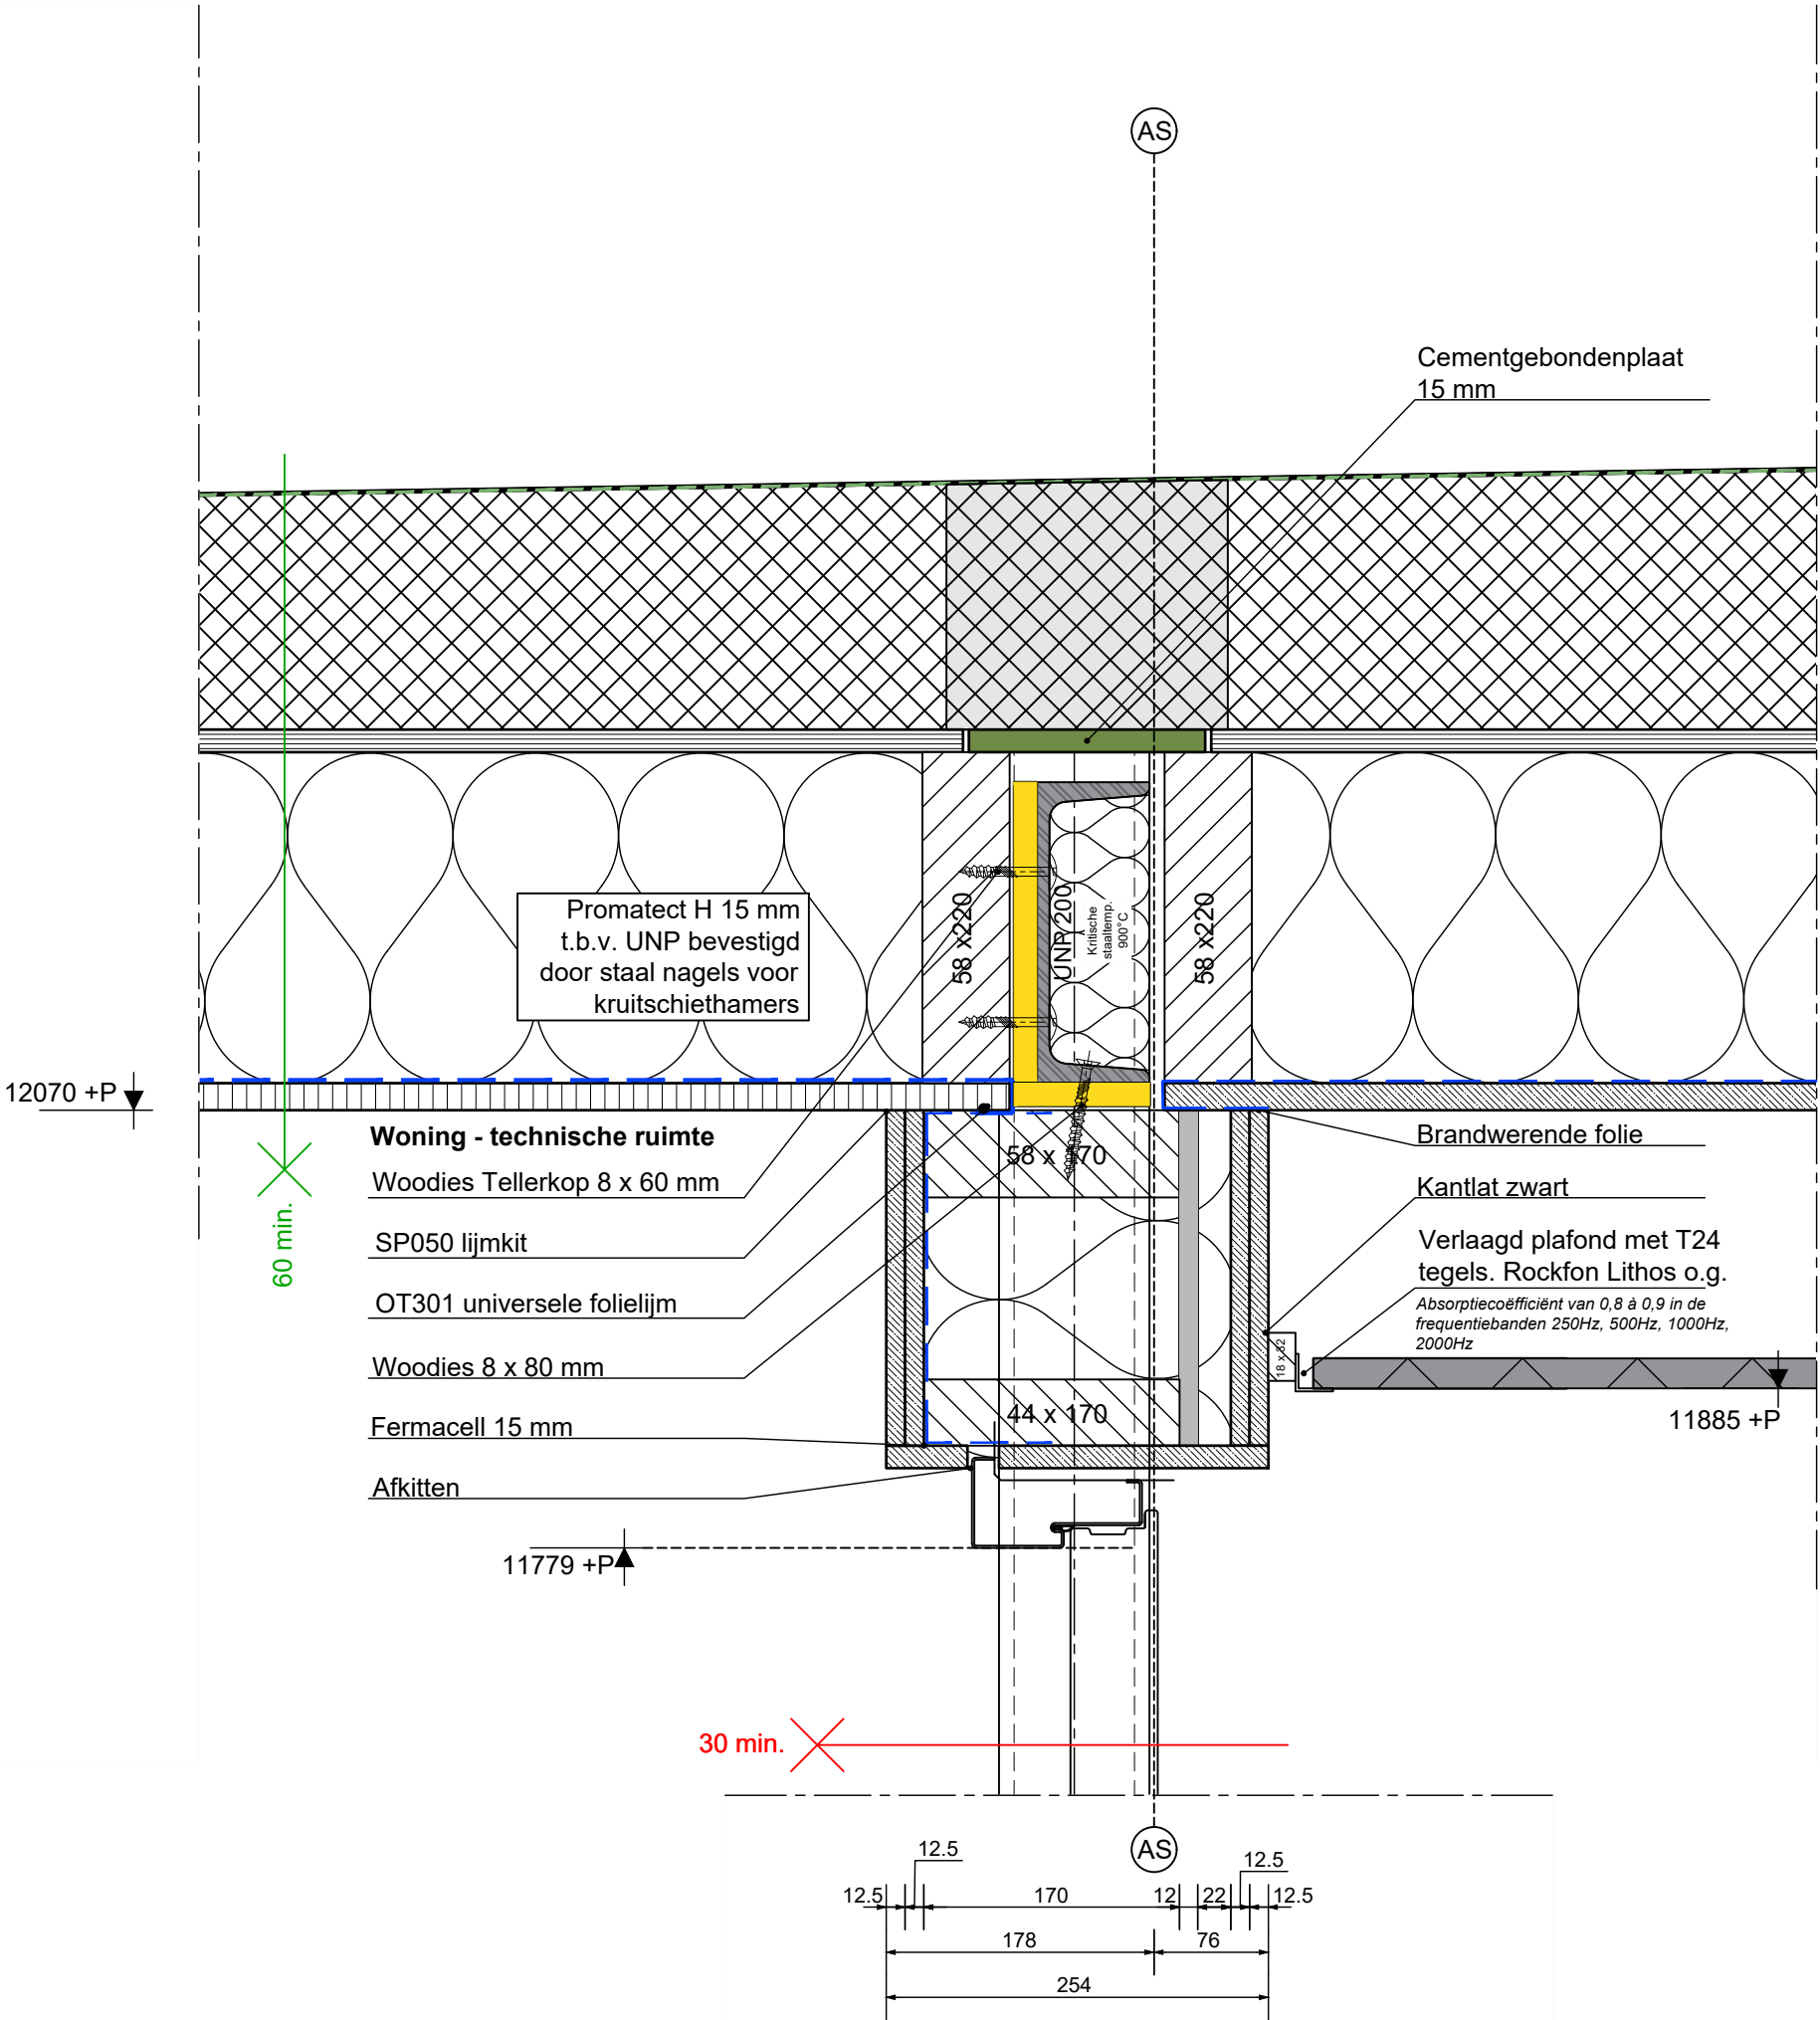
corridor TR deur verdieping		Systeem	Woningbouw	Tekenaar	EvdE	Tek.
